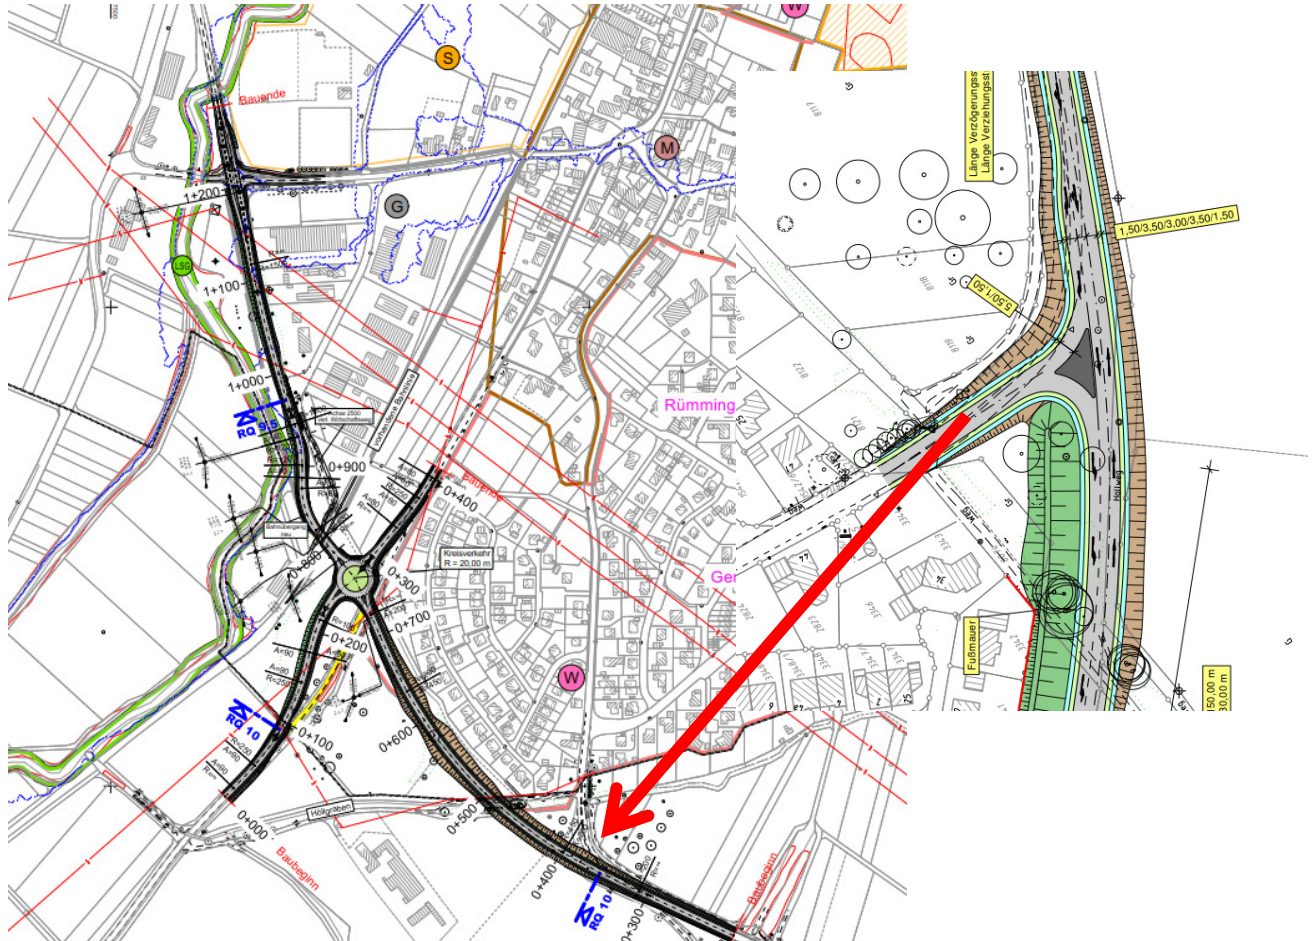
Übersichtslageplan – Linienführung Planfall 4
